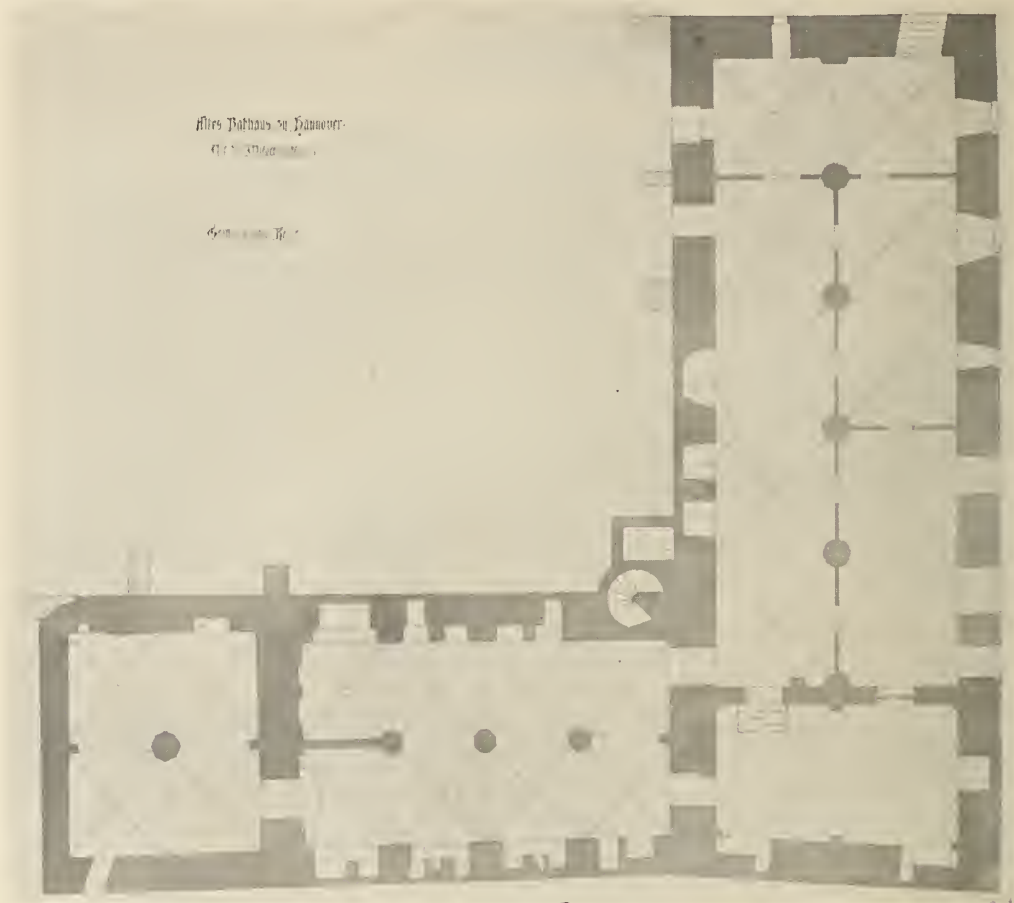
Hannover; Altstädter Rathaus, Grundriß des Kellergeschosses, 1878. Stadtbauamt.
